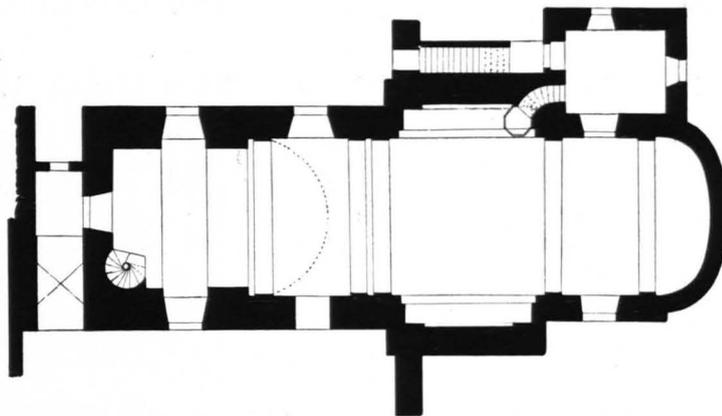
Reinprechtspölla, Pfarrkirche, Grundriß 1:300 (S. 104)
